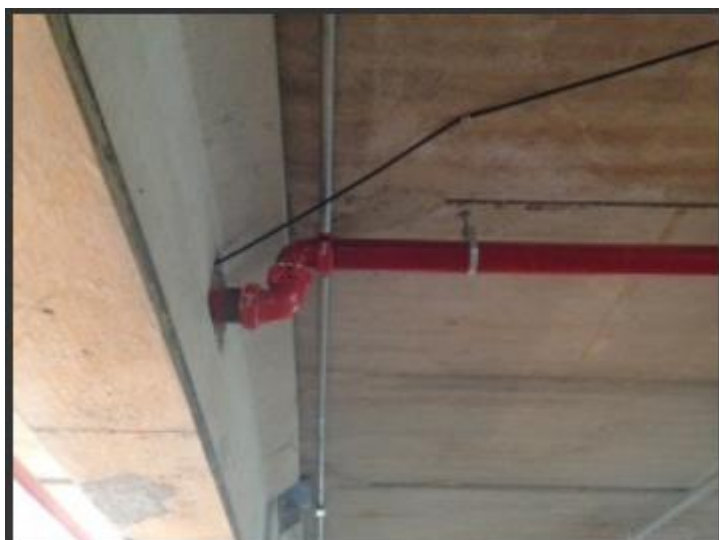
Detalhe da tubulação que transpassa a viga como previsto em projeto
